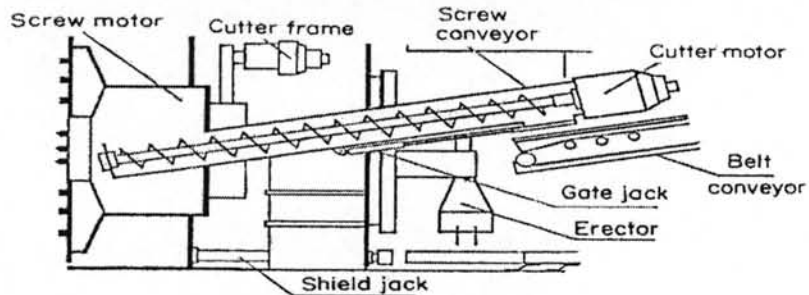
หัวเจาะประเภท Compressed Air Shield (Stack, 1982)
